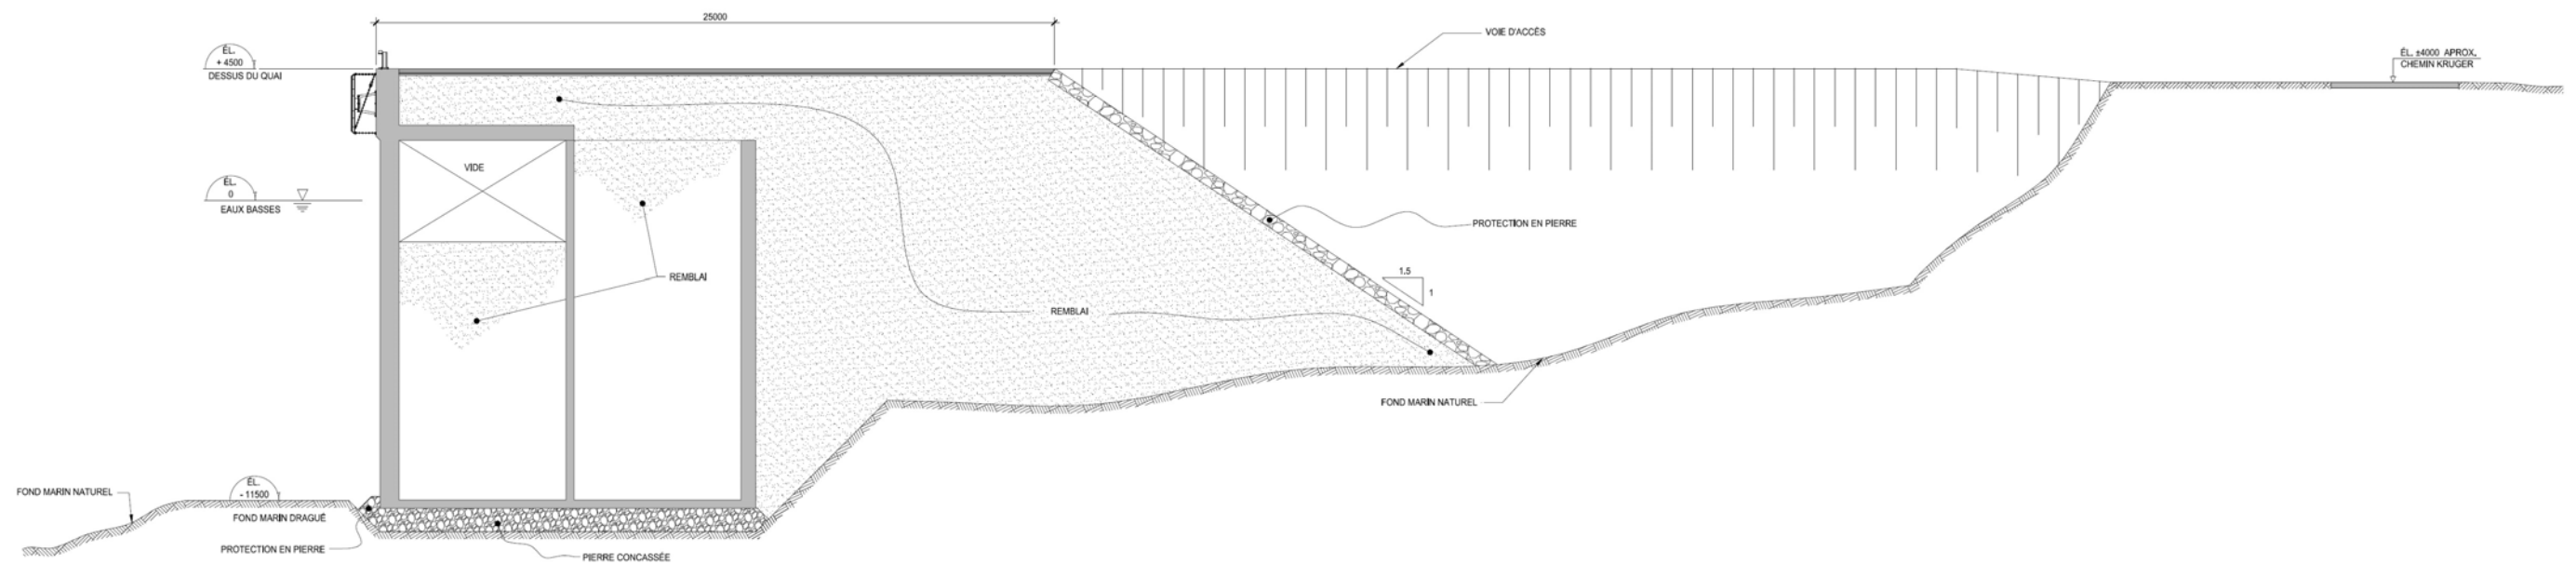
Coupe-type de la variante 2 -Caisson de béton avec aire remblayée de 25 m de large
